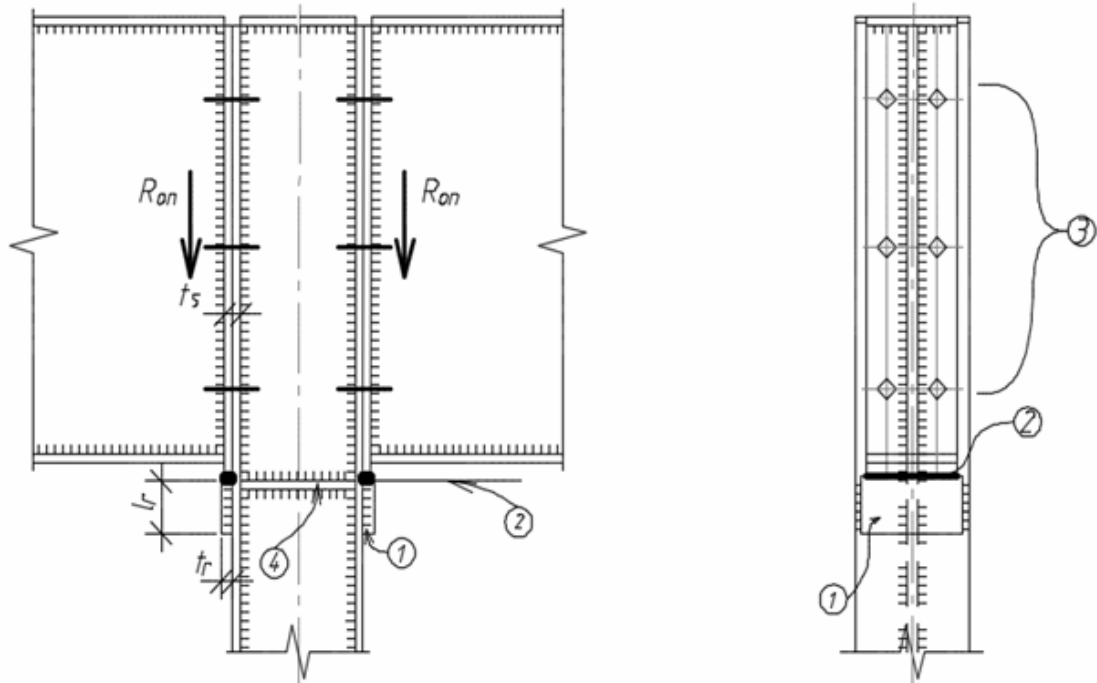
Оголовок з боковим спиранням балок [2–4]:
